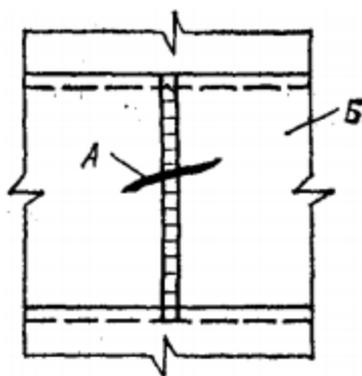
Поперечная трещина А по стыковому сварному шву вертикального стыка стенки Б резервуара, распространившаяся на основной металл
